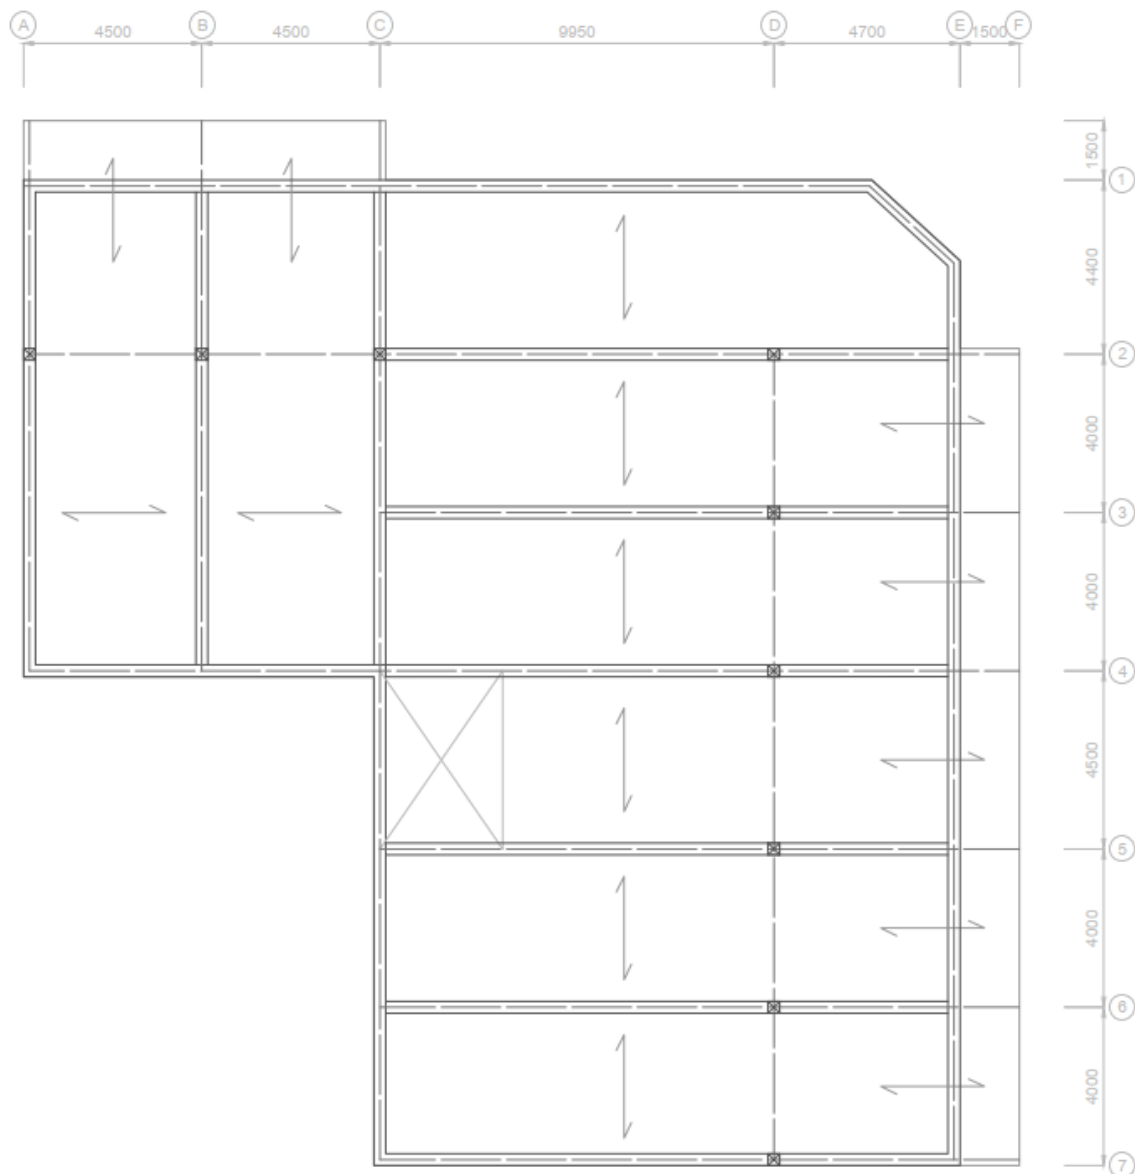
Planta estructural del edificio tipo con estructura de entramado ligero de madera realizada en AutoCAD.
